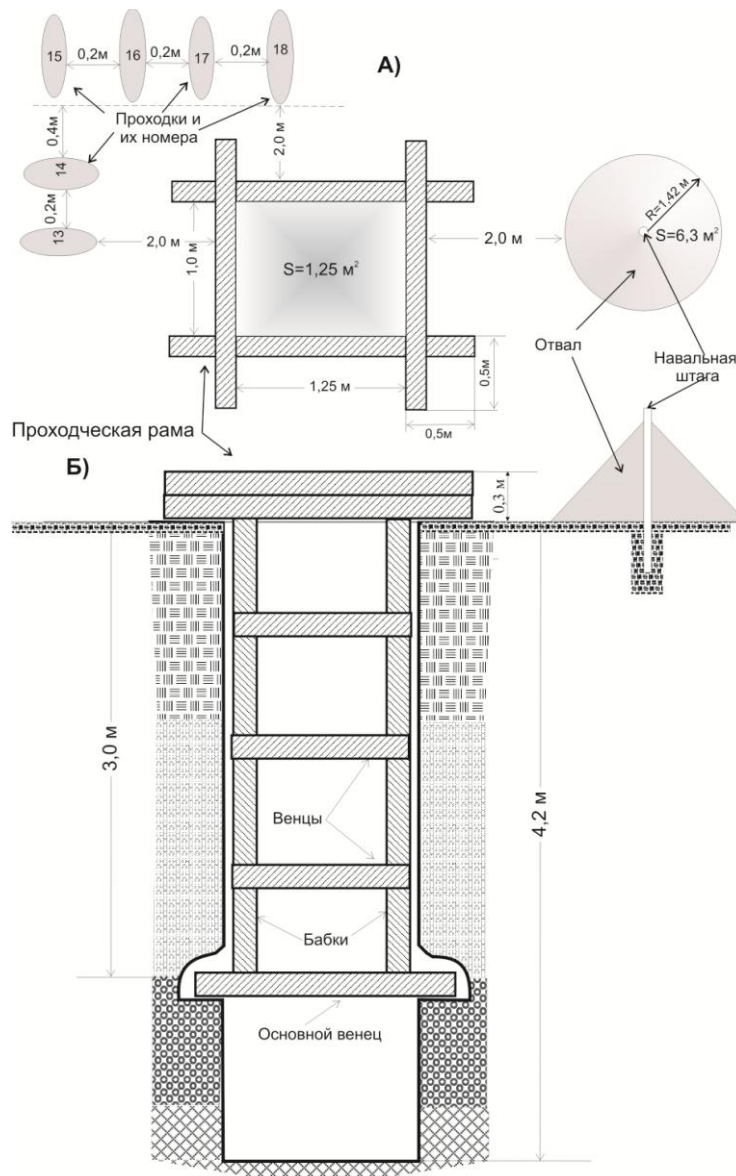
Схема проходки и крепления шурфа: А) план, Б) разрез.
